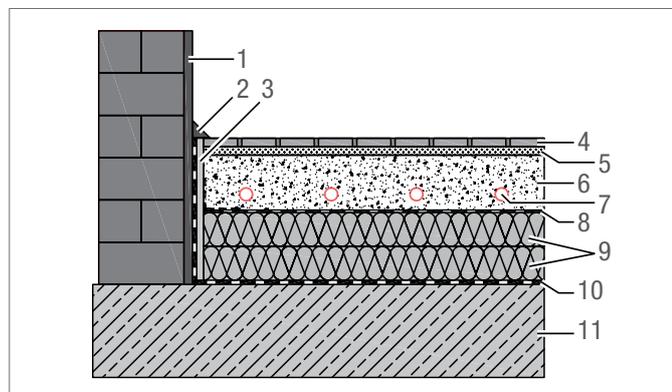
Esempio di sistema di riscaldamento/raffrescamento a pavimento con la costruzione ad umido
